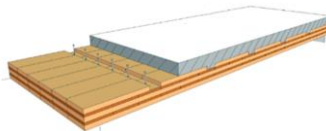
Конструкция плиты перекрытия, состоящая из бетона и CLT-панелей
